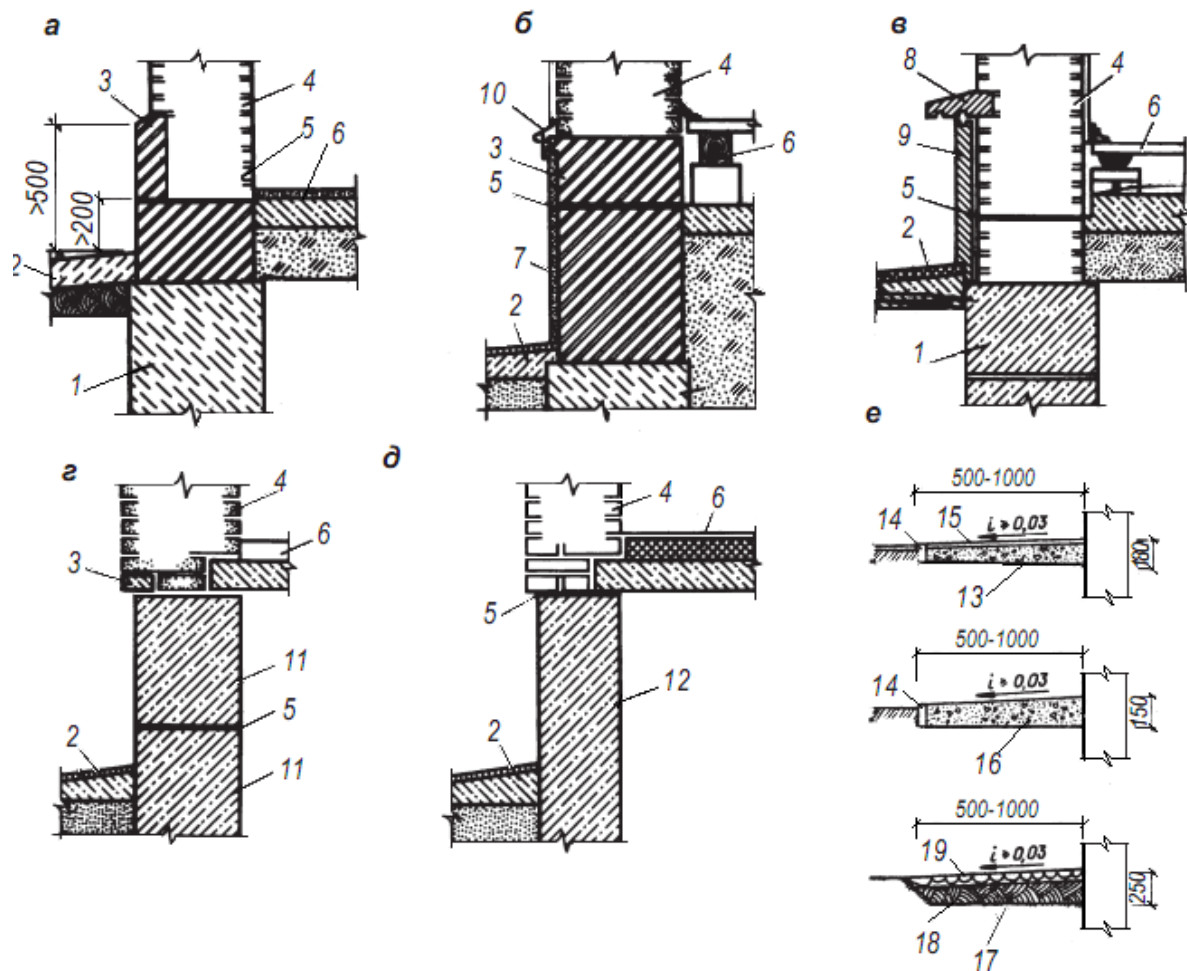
Типи конструкції цоколів: а – облицьований цеглою; б – обштукатурений; в – облицьований плитами; г – із бетонних блоків у підрізку; д – із залізобетонних панелей у підрізку; е – конструкція вимощення; 1 – фундамент; 2 – вимощення; 3 – випалена цегла; 4 – стіна; 5 – гідроізоляція; 6 – конструкція підлоги першого поверху; 7 – штукатурка; 8 – бортовий цокольний камінь; 9 – облицьовані плити; 10 – дахова сталь; 11 – бетонний блок; 12 – панель фундаментної стіни; 13 – щебінь; 14 – бортовий камінь; 15 – асфальт завтовшки – 30 мм; 16 – бетон класу В7,5; 17 – м'ята глина, завтовшки – 150 мм; 18 – пісок – 100 мм; 19 – буличжний камінь
